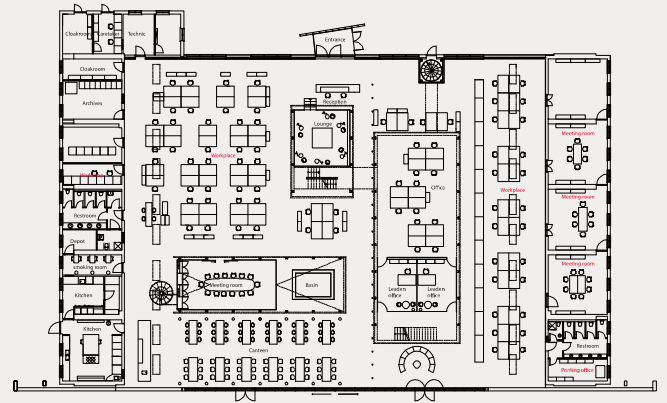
Vandflyverhangaren. Stueplan. 1:800. Dorte Mandrup Arkitekter.
